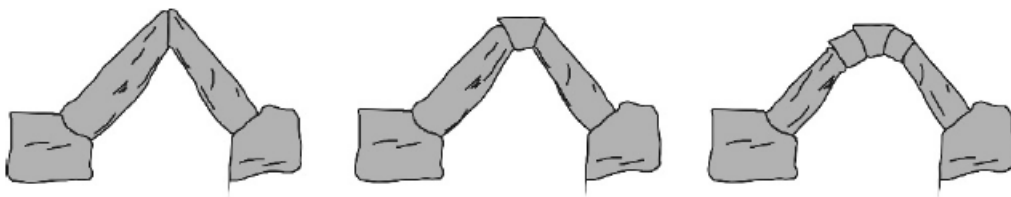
subdivisão de vigas de pedra em elementos únicos (Proske e Gelder, 2009)
